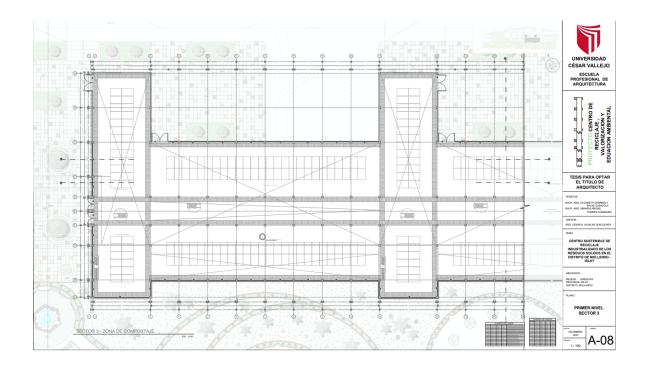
Planta de Distribución, Sector 3 – Primer Nivel FUENTE: Elaboración Propia
